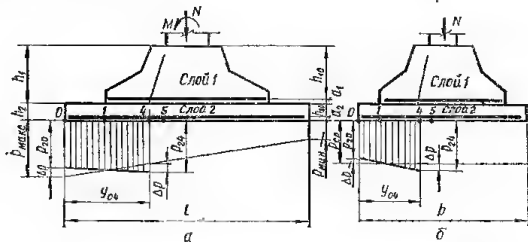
Расчетные схемы двухслойного фундамента:
